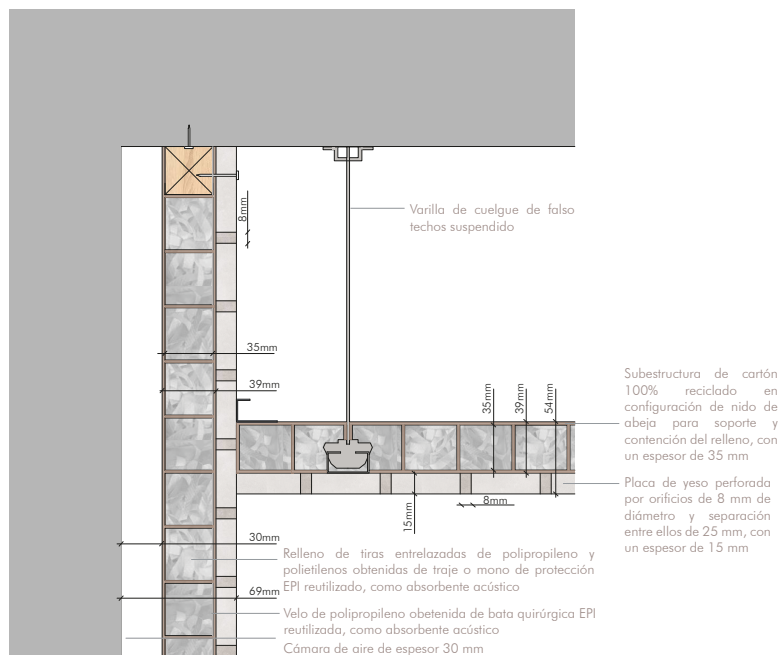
Detalle constructivo del encuentro entre el trasdosado y el falso techo propuesto. Fuente: elaboración propia
